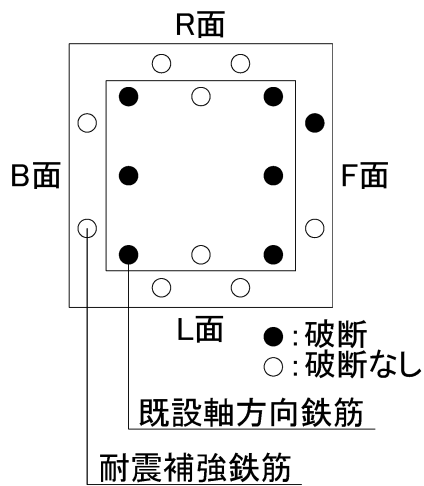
耐震補強鉄筋のはらみ出しおよび破断状況
